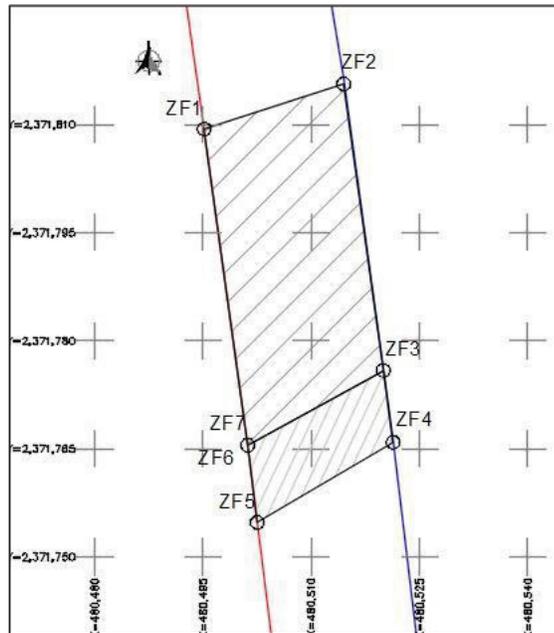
Muestra el polígono de construcción y las zonas delimitadas por SEMARNAT
